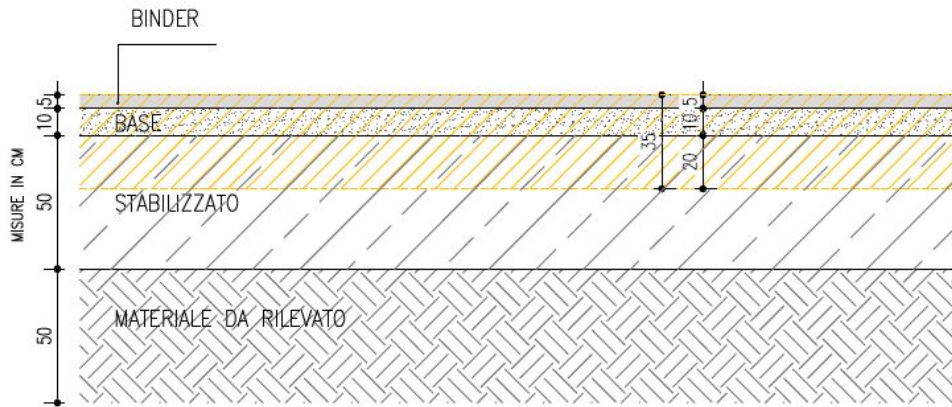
Esempio di pavimentazione di cantiere di cui demolire lo strato superficiale del manto
